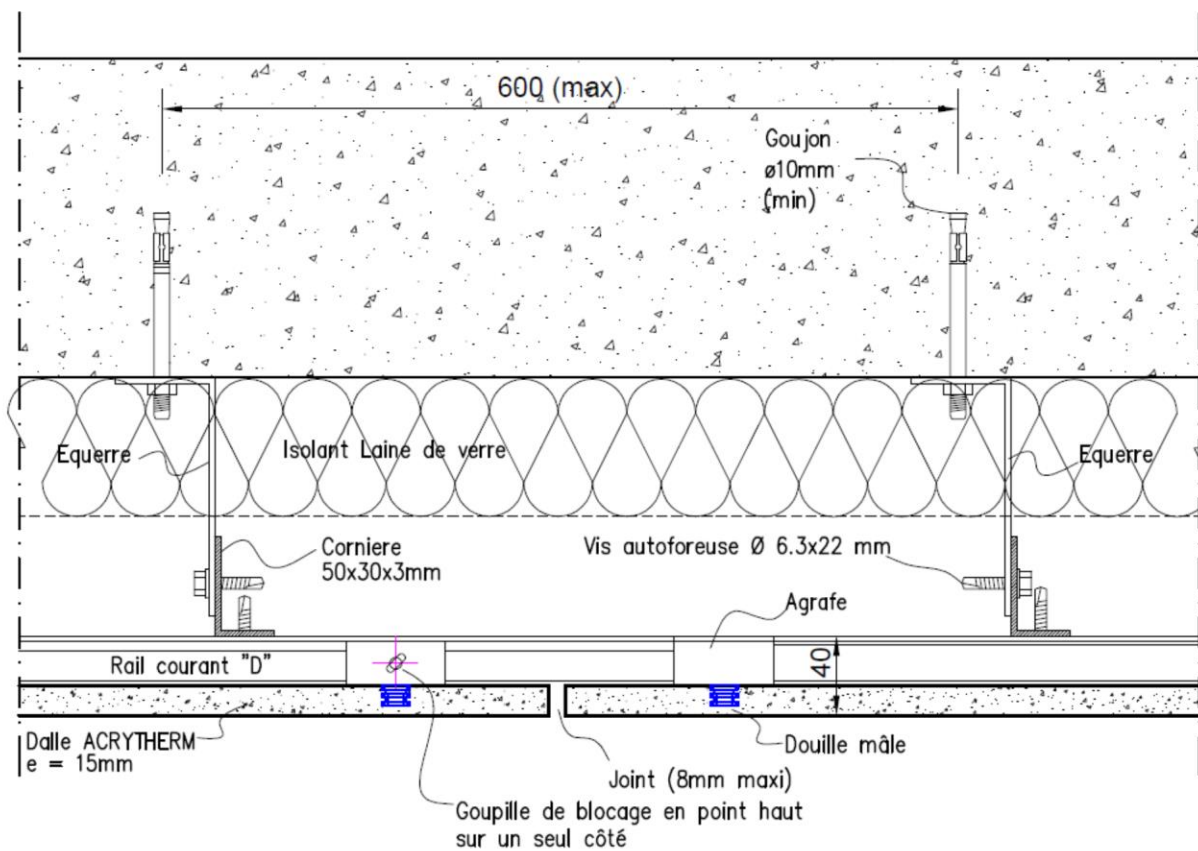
Coupe horizontale sur joint vertical avec douille mâle
